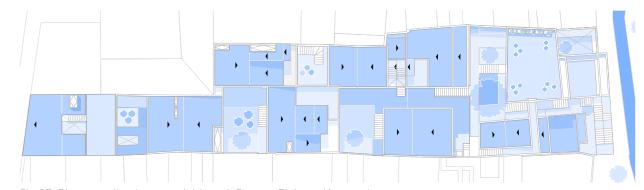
Planta explicativa casa del Nogal. Fuente: Elaboración propia
